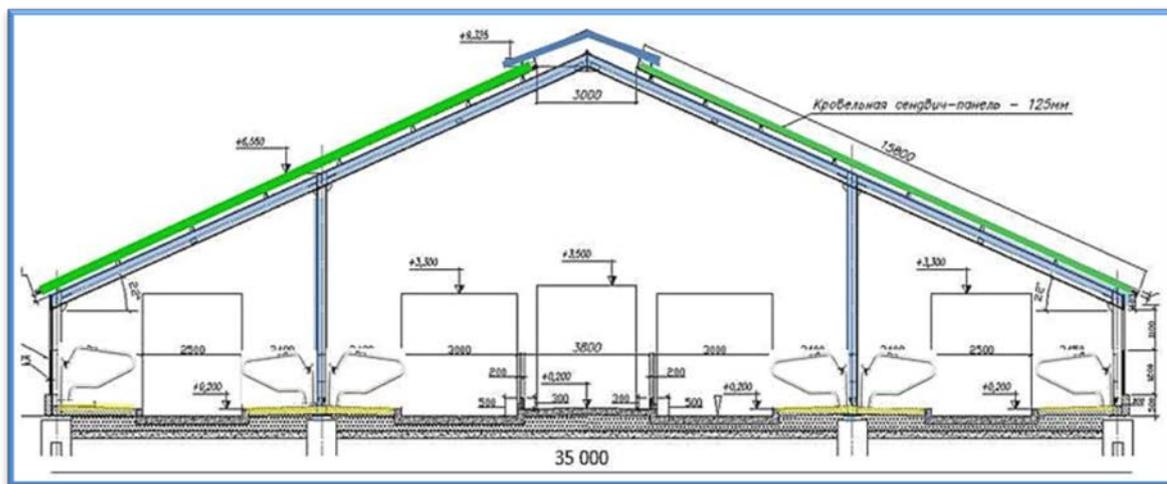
Широкогабаритный коровник из металлических конструкций
